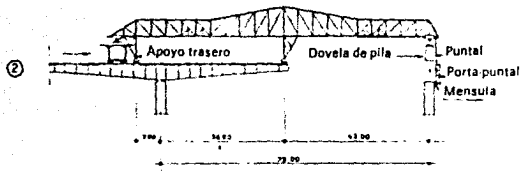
MONTAJE CON VIGA DE LANZAMIENTO
